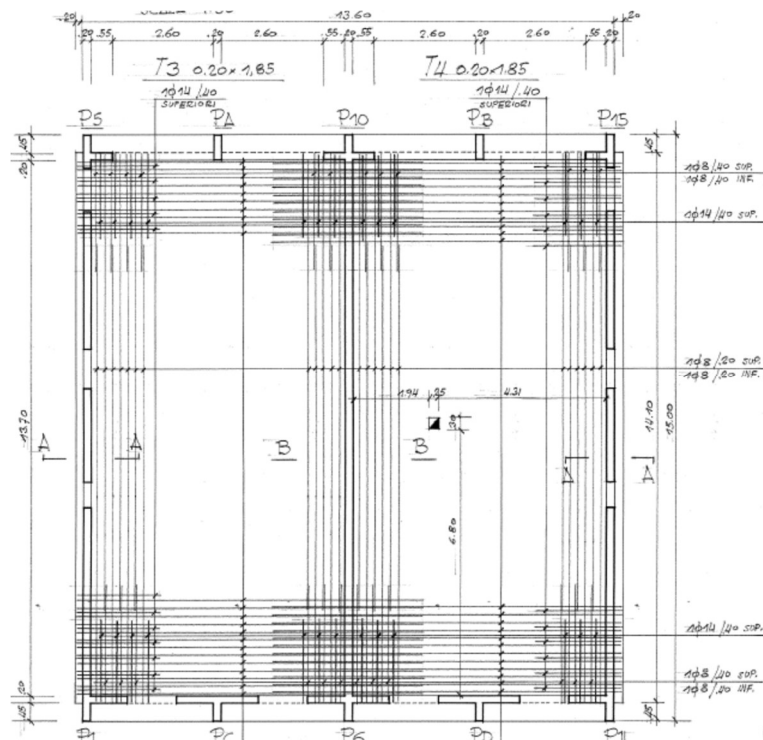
Progetto di esecutivo del 1985 – Pianta della copertura
